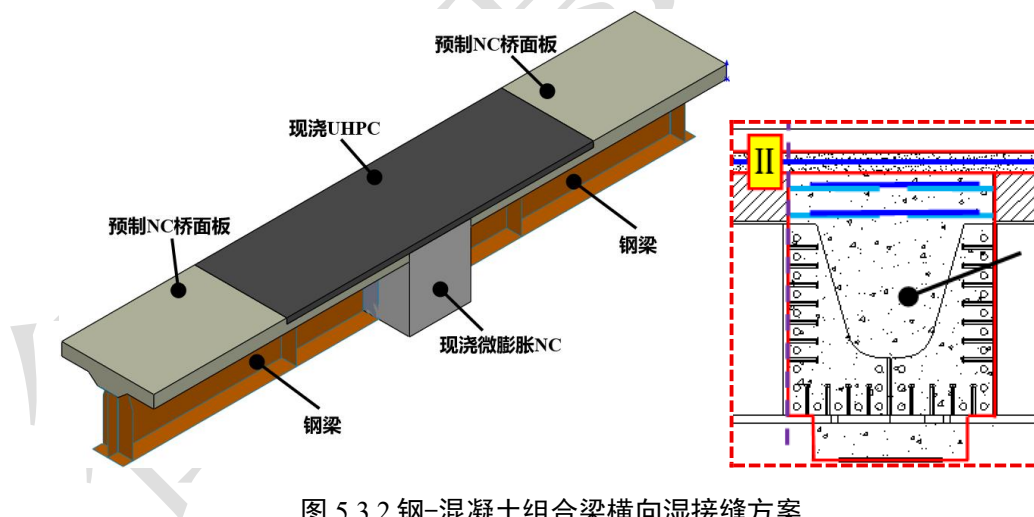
钢-混凝土组合梁横向湿接缝方案
